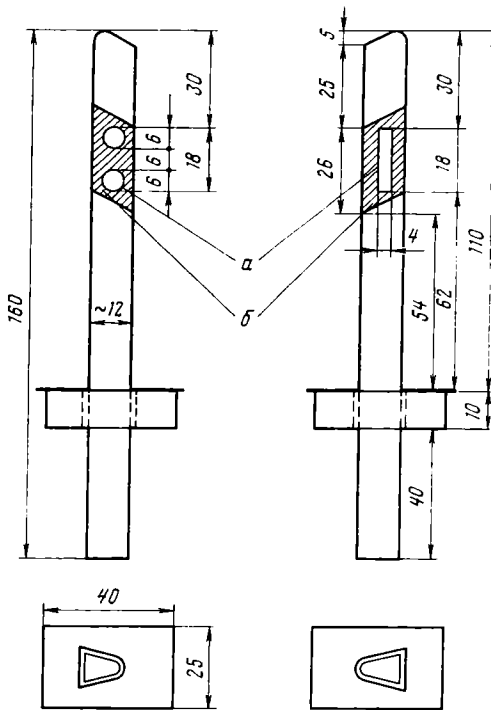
Железобетонные, пластмассовые или деревянные направляющие столбики:
